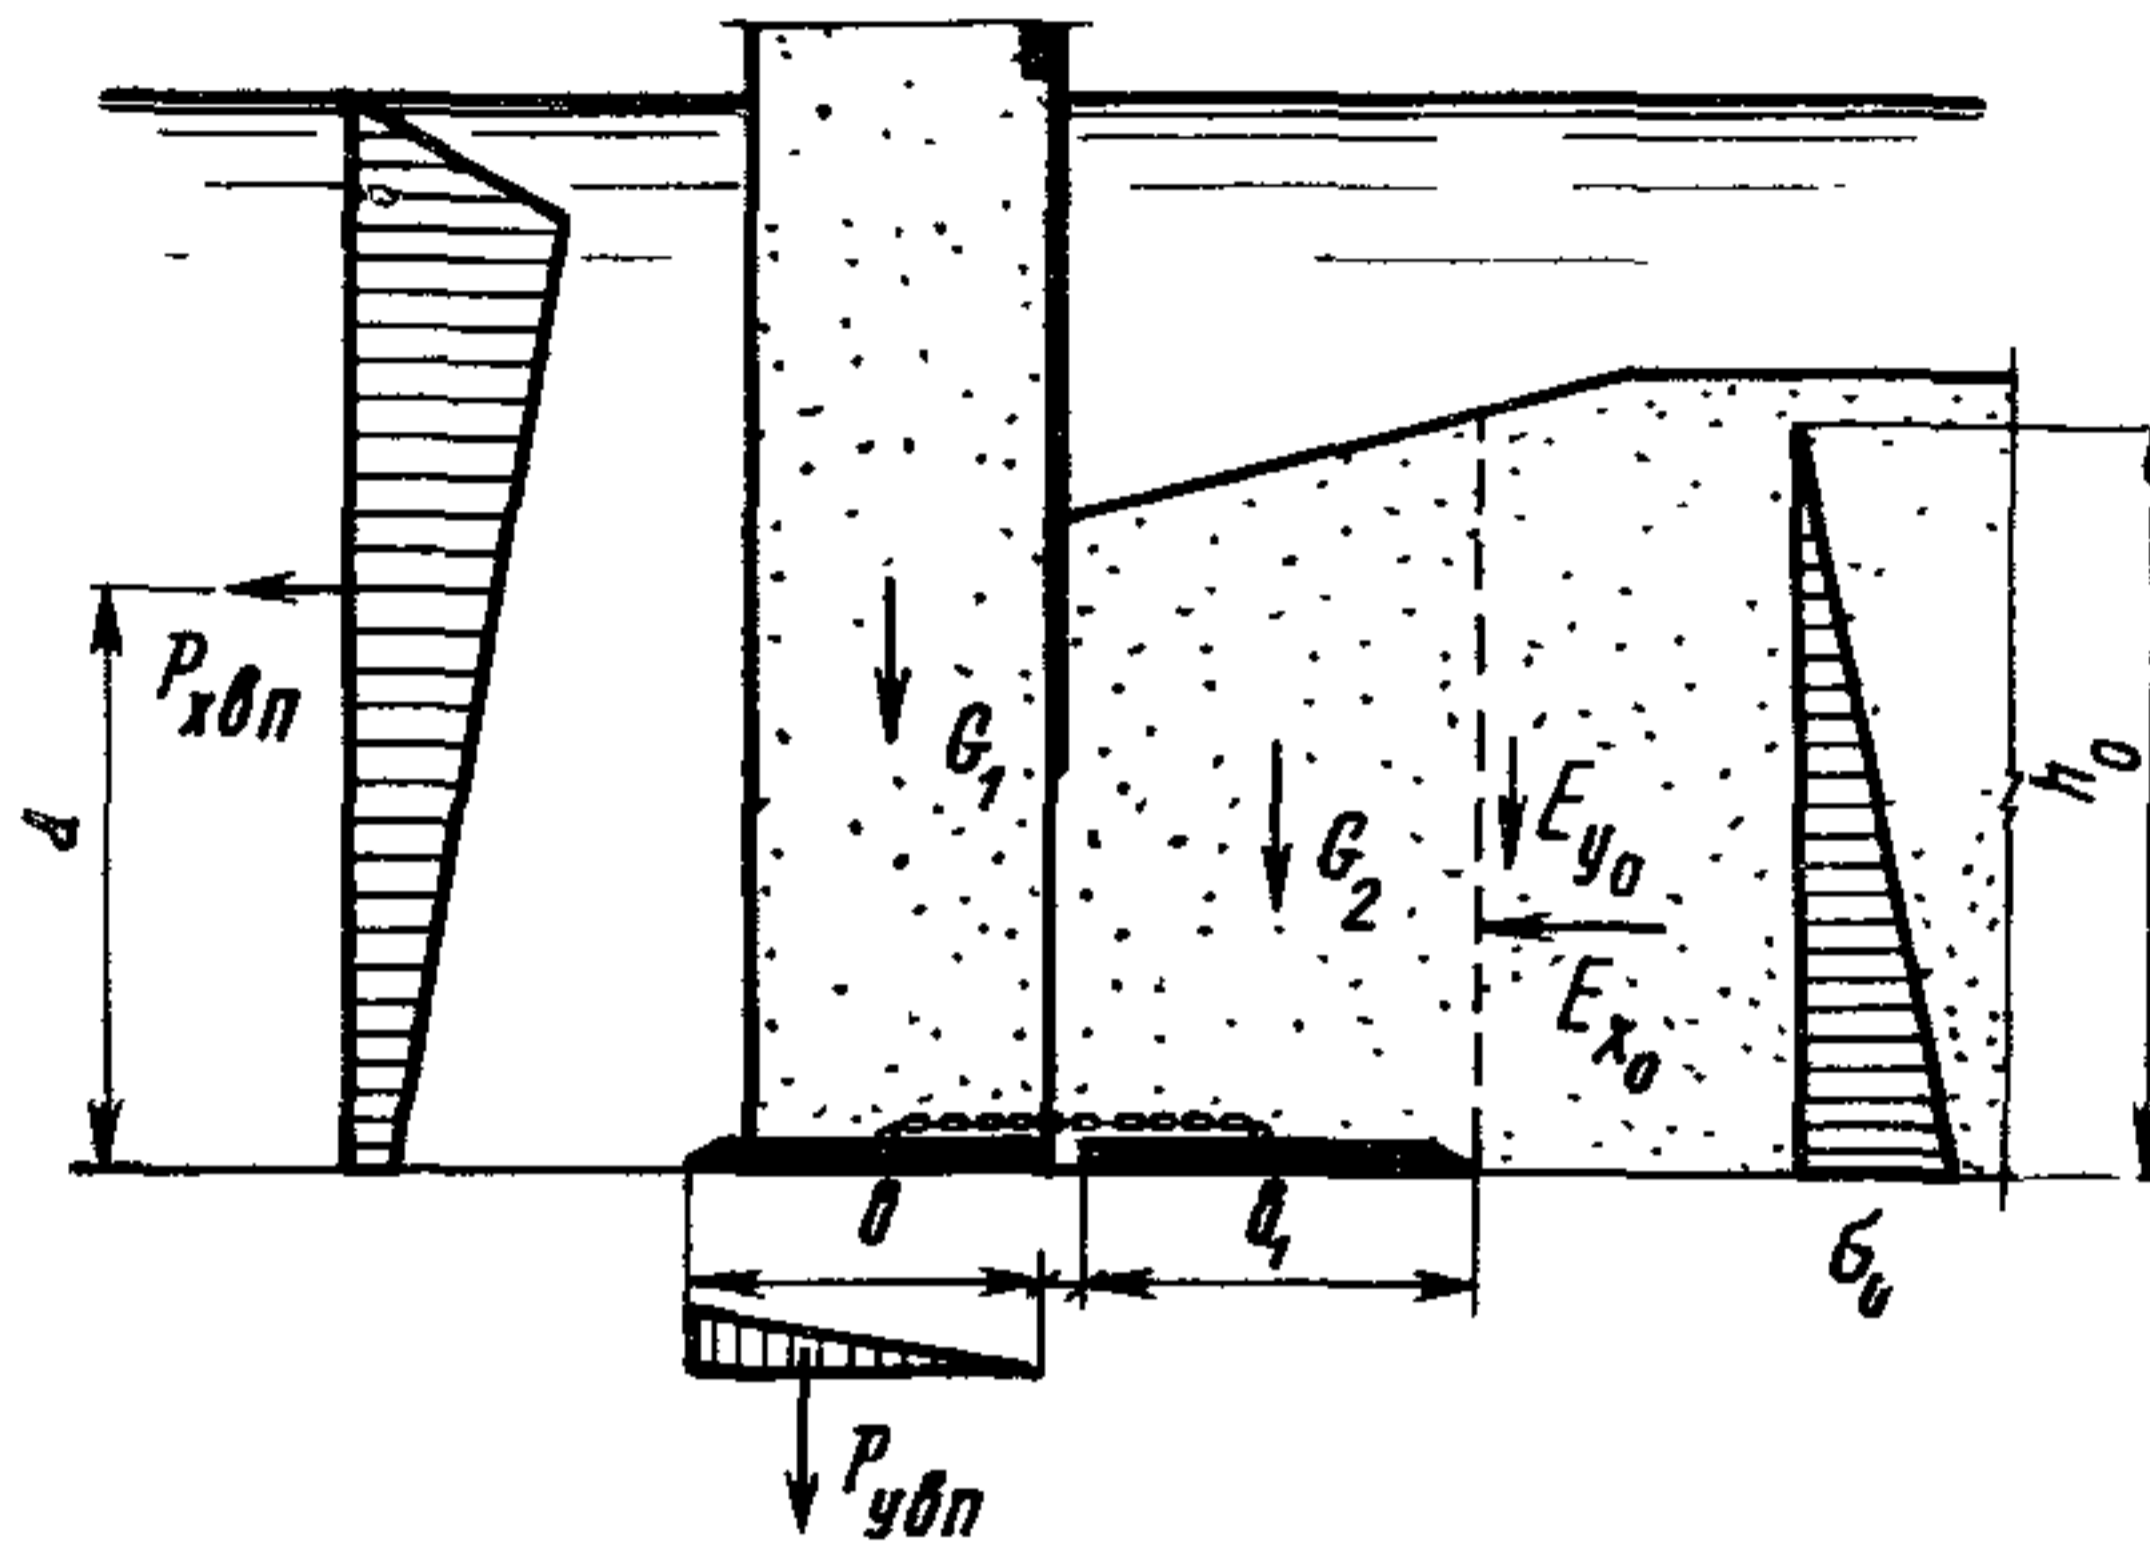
Схема к расчету устойчивости на сдвиг в строительный период
